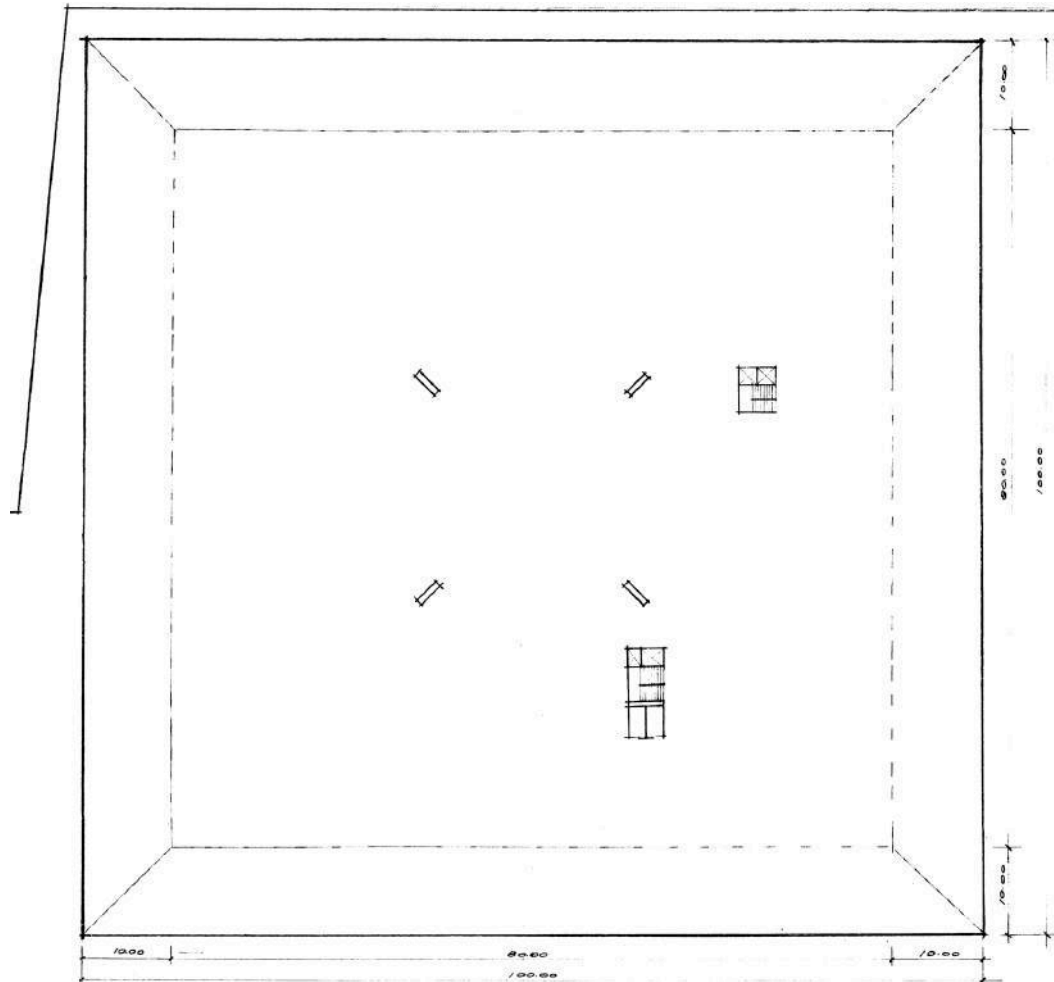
BNB, planta baixa – 2º.subsolo, 1969. Fonte: ArqPDF.
